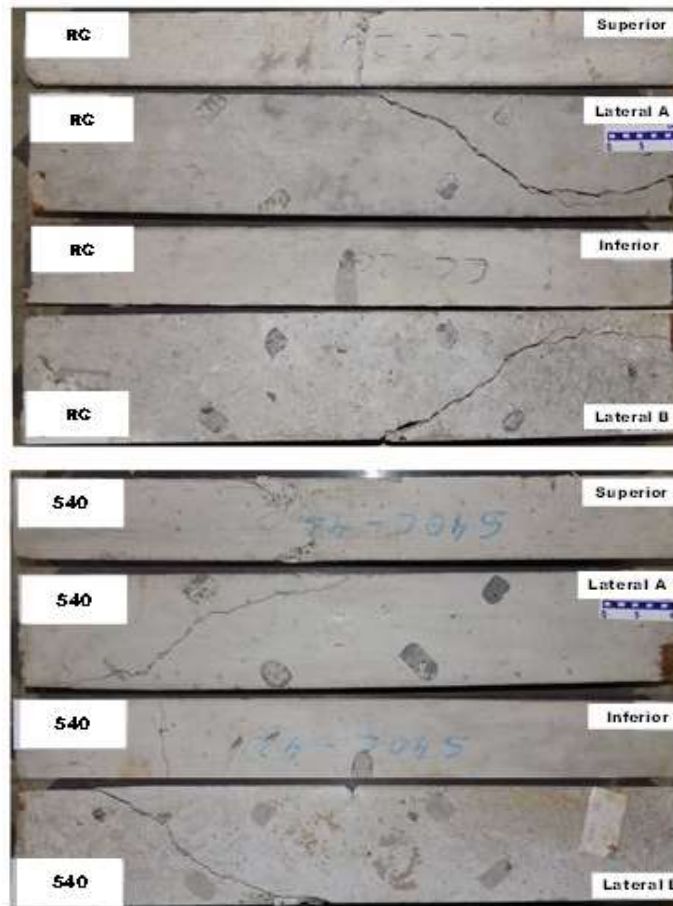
Imagen de la fisura de corte que generó el colapso de las vigas.
